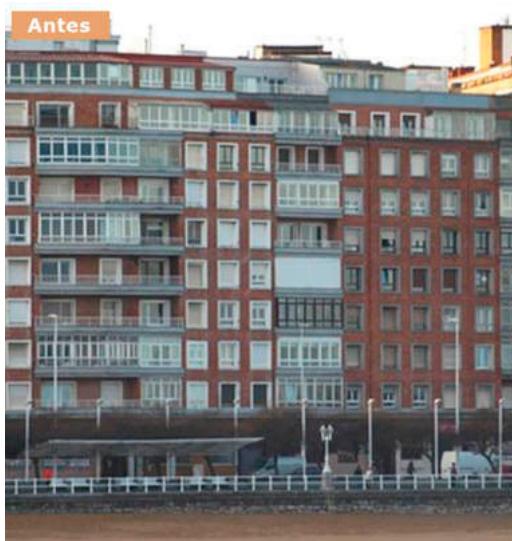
Rehabilitación de la fachada marítima del Muro de San Lorenzo en Gijón, del arquitecto Diego Cabezudo Fernández. *Fuente: www.esfer.es
